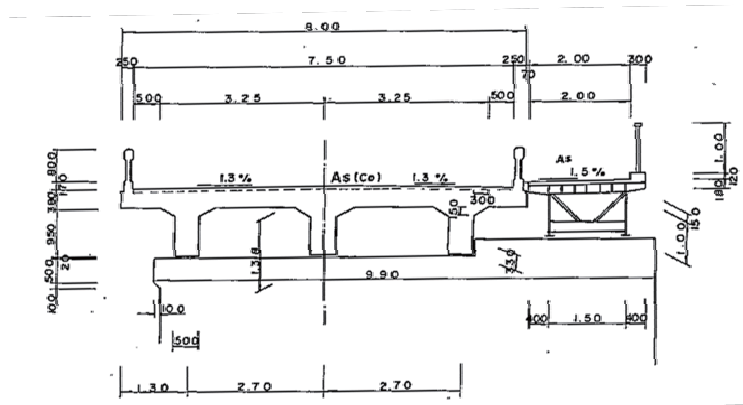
(2) 橋梁一般図(旧鮫川橋)
